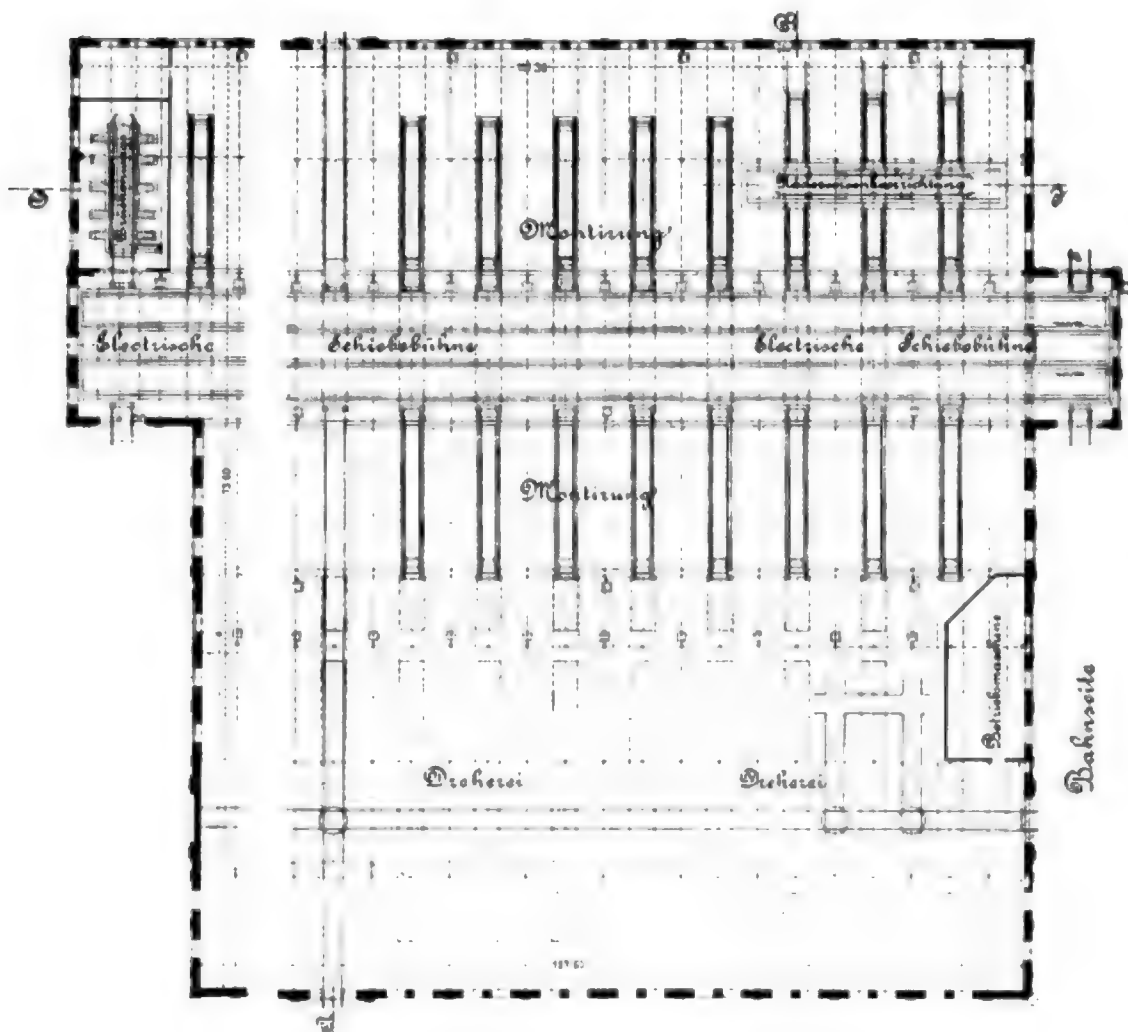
Grundriss der Montierungswerkstätte. 1:500.
